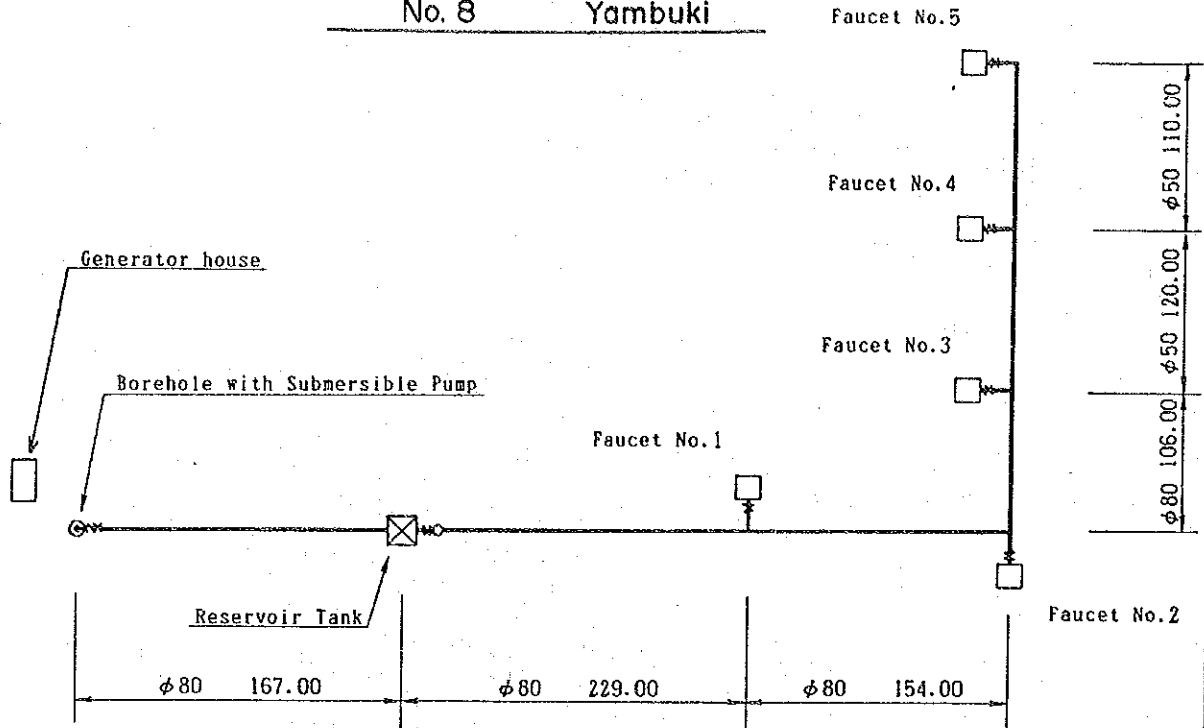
給水施設配置図 No. 8 ヤンブキ村
